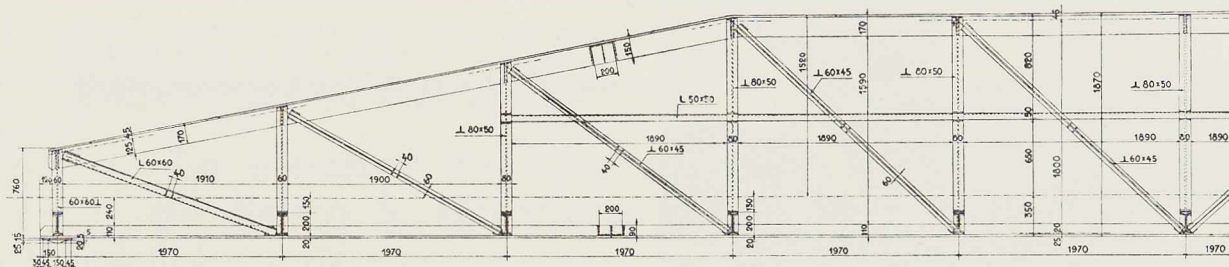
Schéma d'une des maîtresses poutres entièrement soudées.
